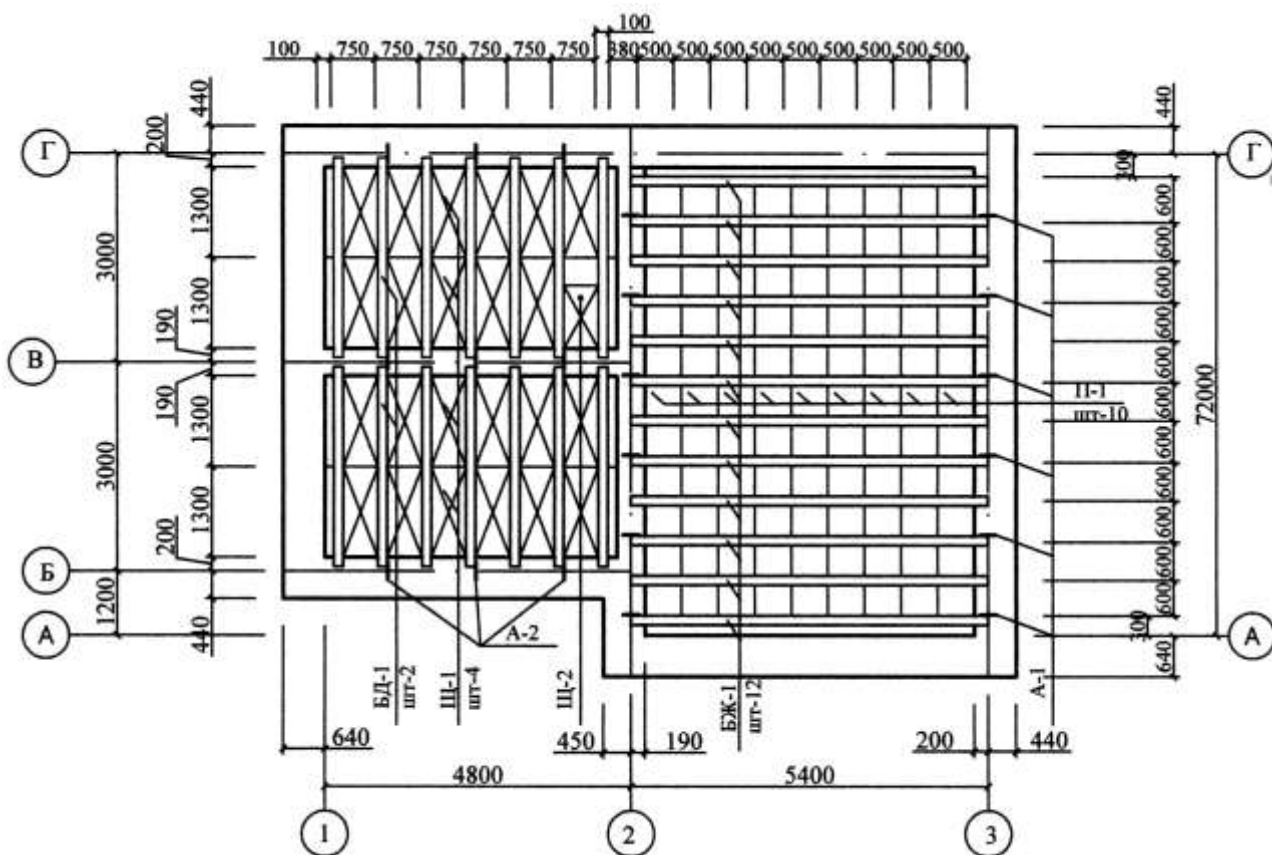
План перекрытия по деревянным и железобетонным балкам (БД – балка деревянная, БЖ – балка железобетонная, Щ – щит наката, П – плита, А – анкеры)
